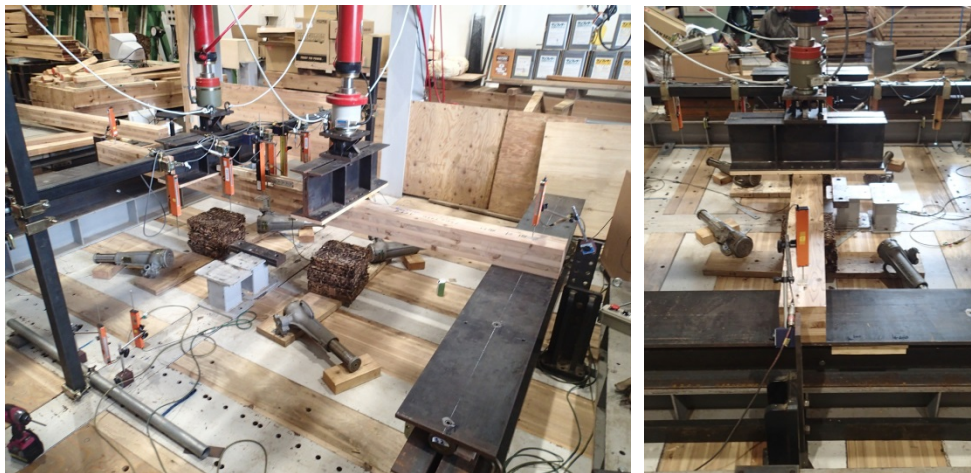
面外曲げ試験状況 (幅 150mm)
